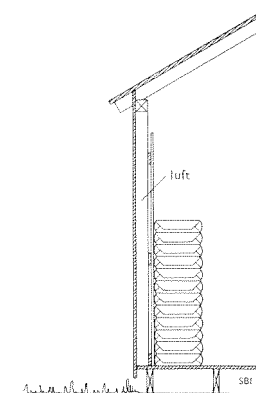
Cementen holdes tør ved stabling i en afstand af 10–15 cm fra ydervæggen.
